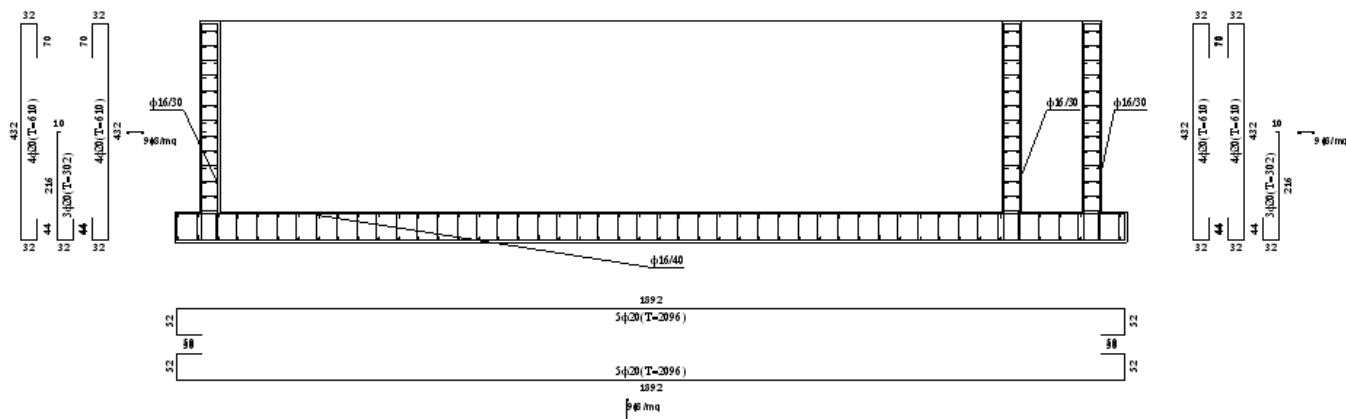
Schema delle armature, sezione longitudinale di maggior altezza dell’opera di derivazione (spessore piedritti 40 cm)
